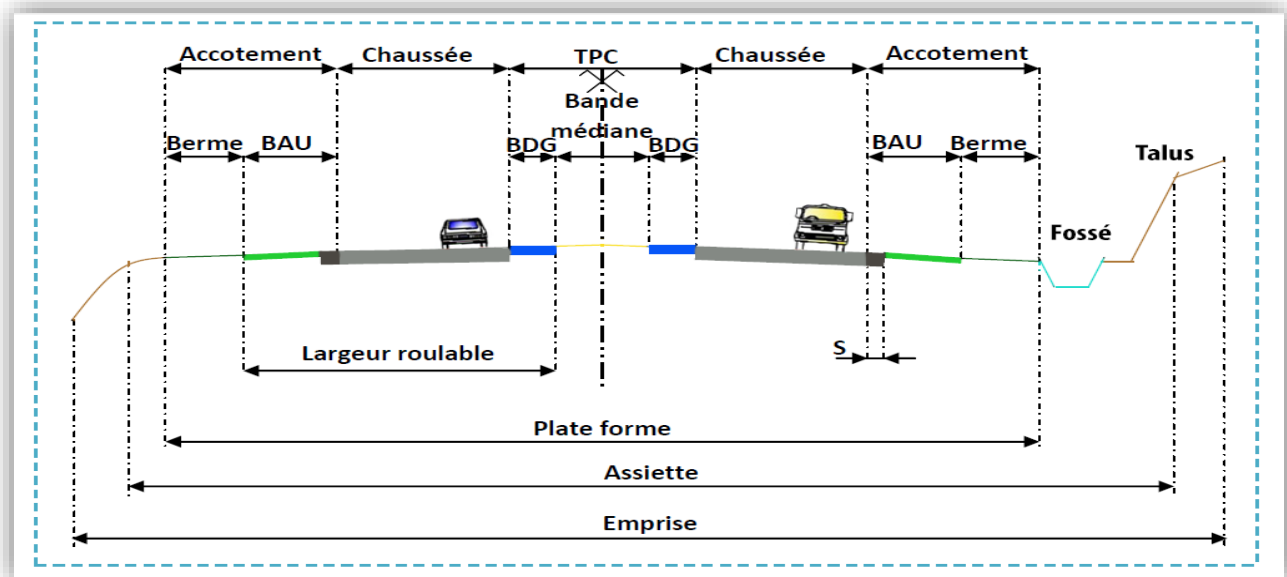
Eléments constitutifs du profil en travers en section courante
